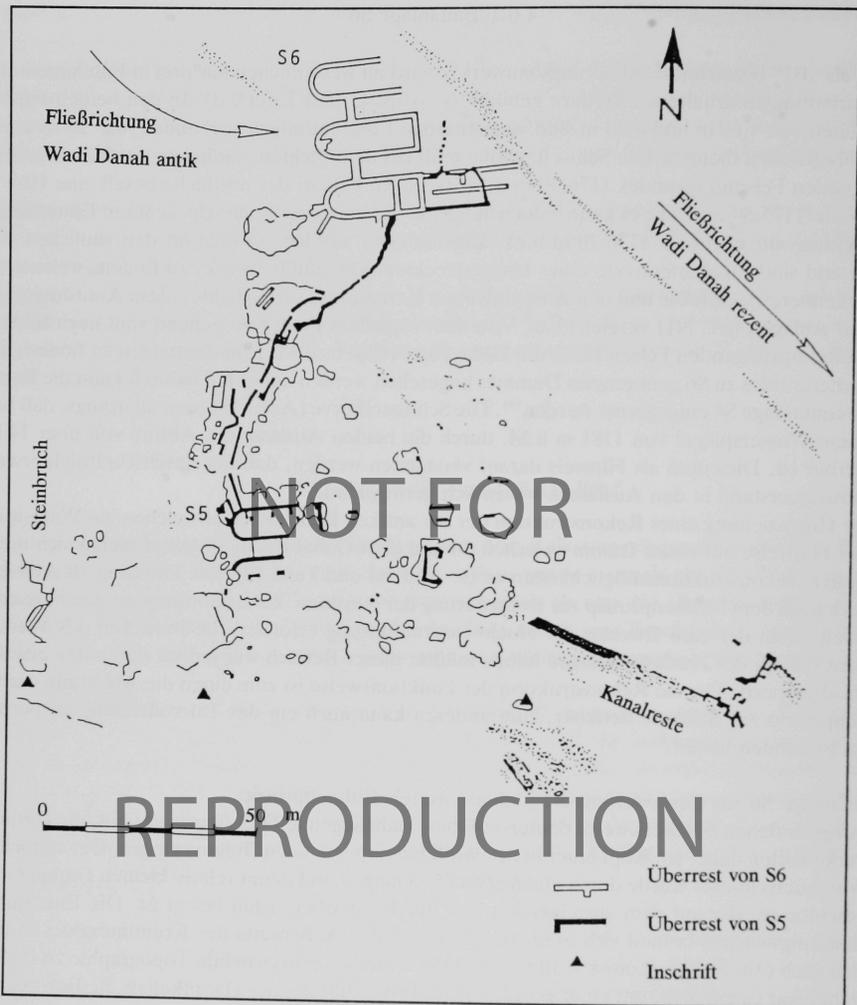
Grundriß der Überreste der Bauanlage S6/5 („Bau B“) aus: Herberg: Baukomplex B, a.O. (s. Anm. 53).
